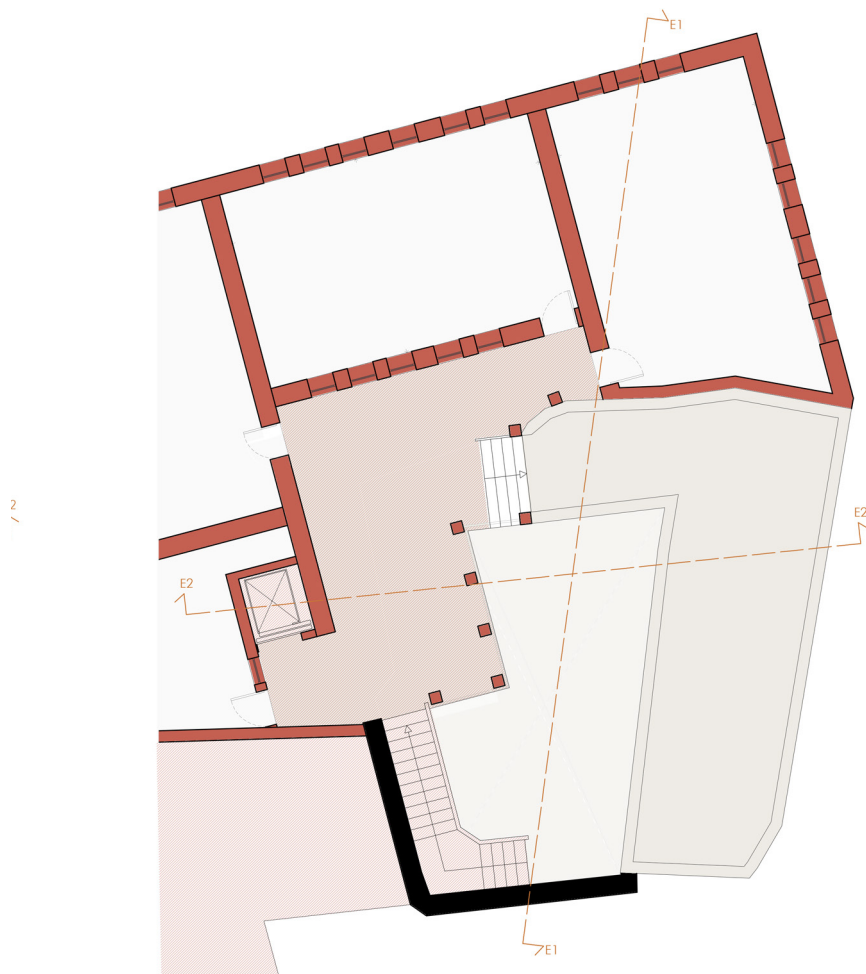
Interventi di costruzione al primo piano | Scala 1/200
